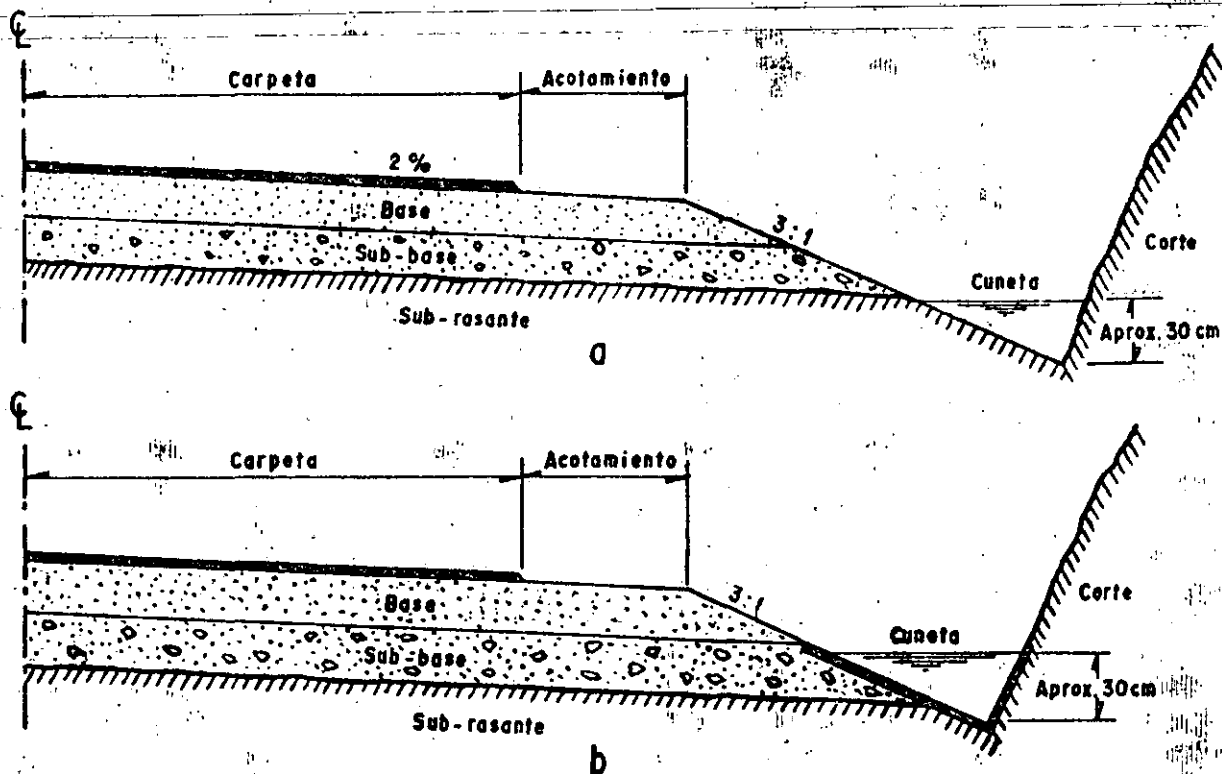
Disposición más conveniente de la cuneta, respecto al pavimento. Sección en corte, sin subdrenaje.
